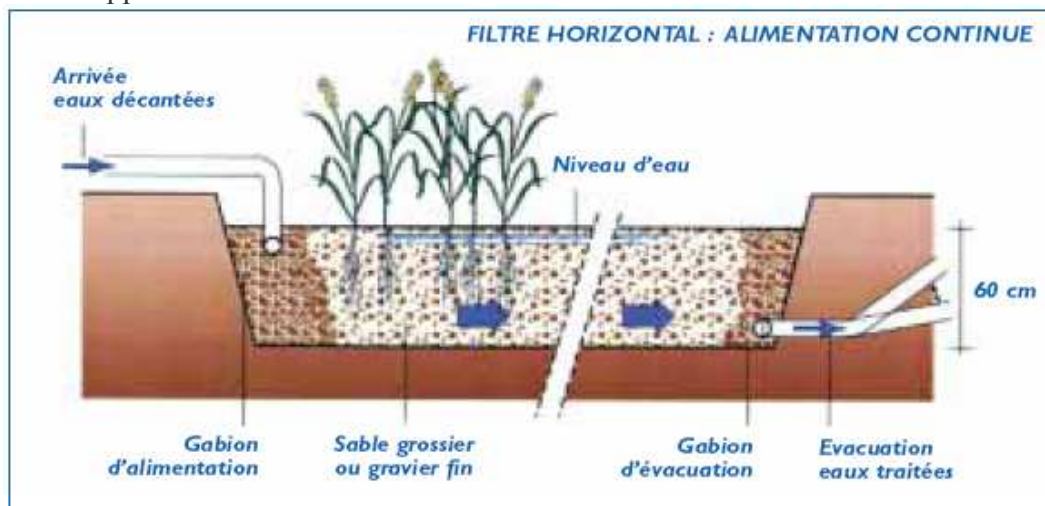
Coupe transversale d'un filtre planté de roseaux à écoulement horizontal
